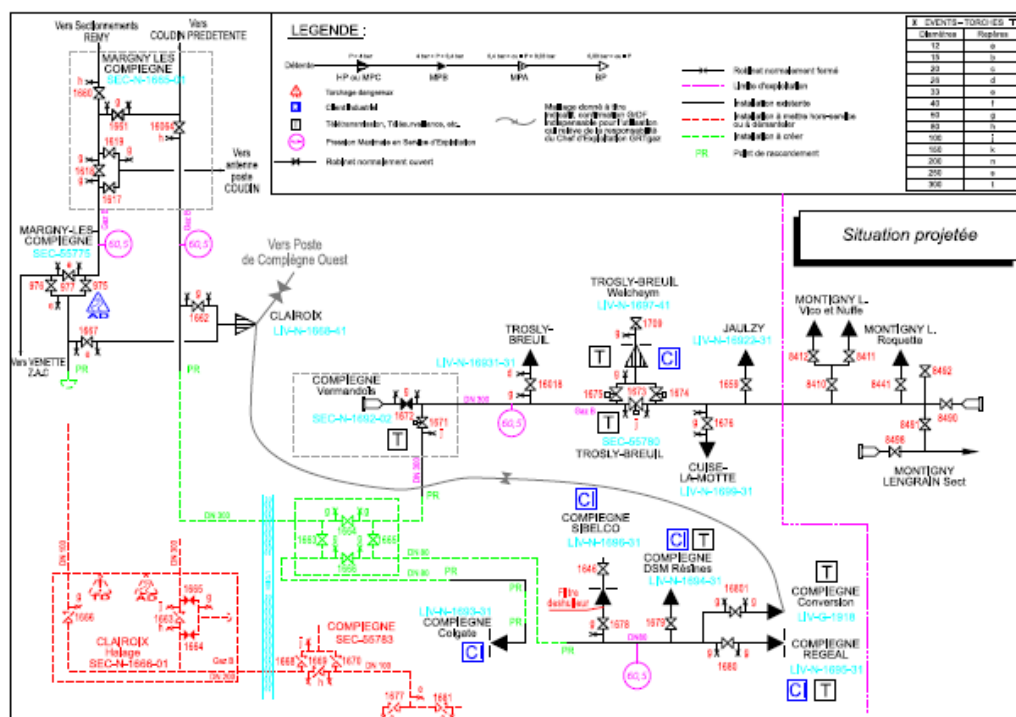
Schéma d'armement de l'ouvrage, après restructuration
